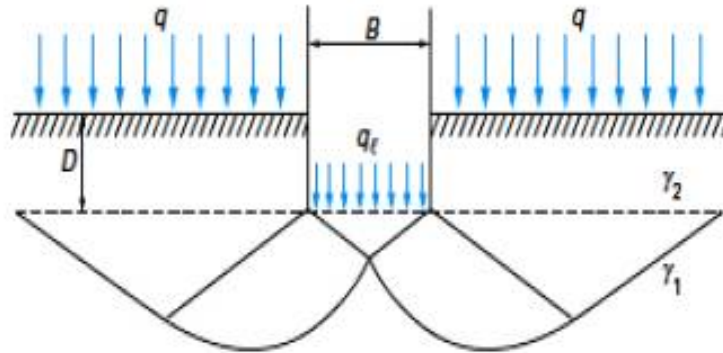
Schéma de rupture d'une fondation superficielle
